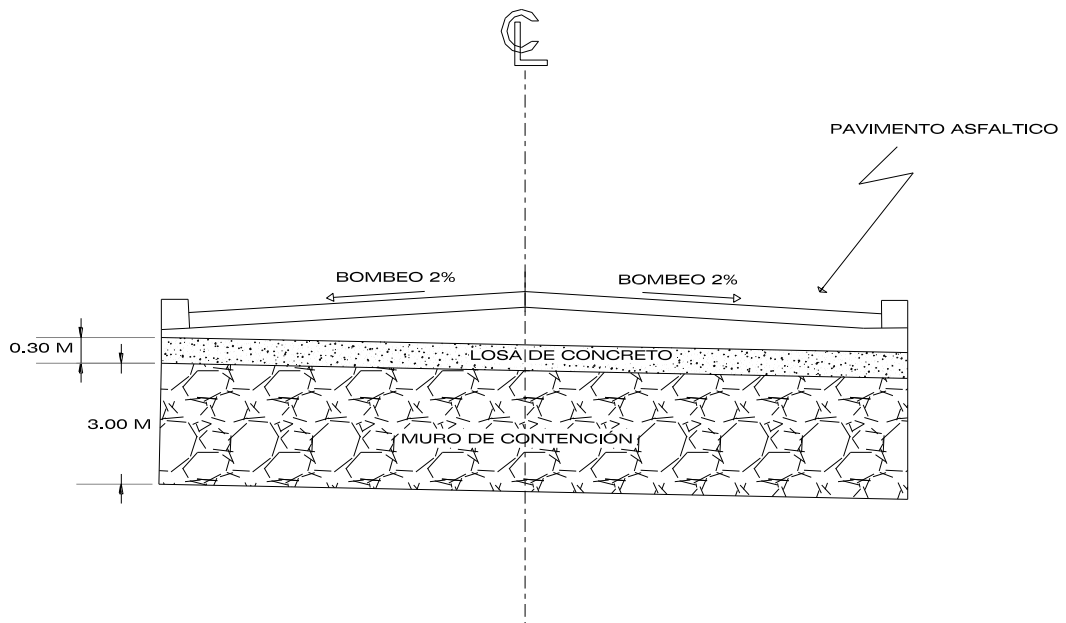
Corte longitudinal A-A' alcantarilla 1 Km. 4+069.35
